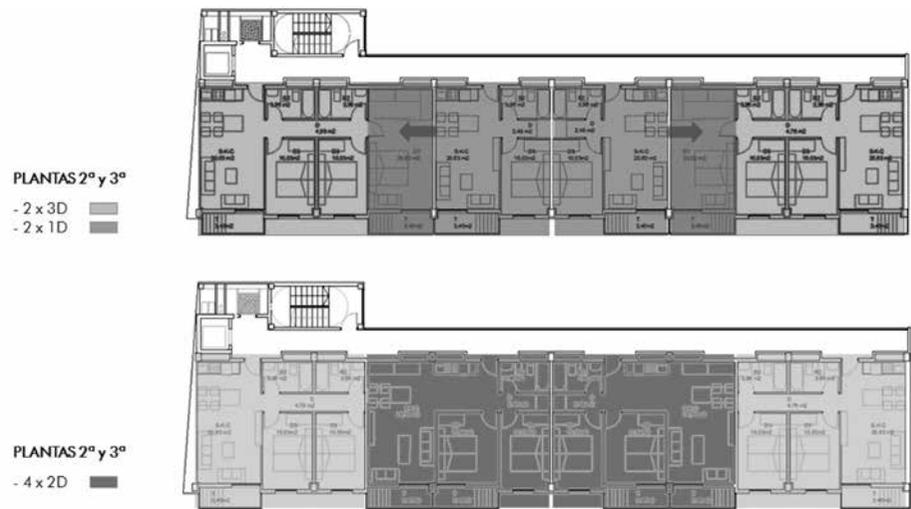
Plantas de viviendas y sus posibles transformaciones.
